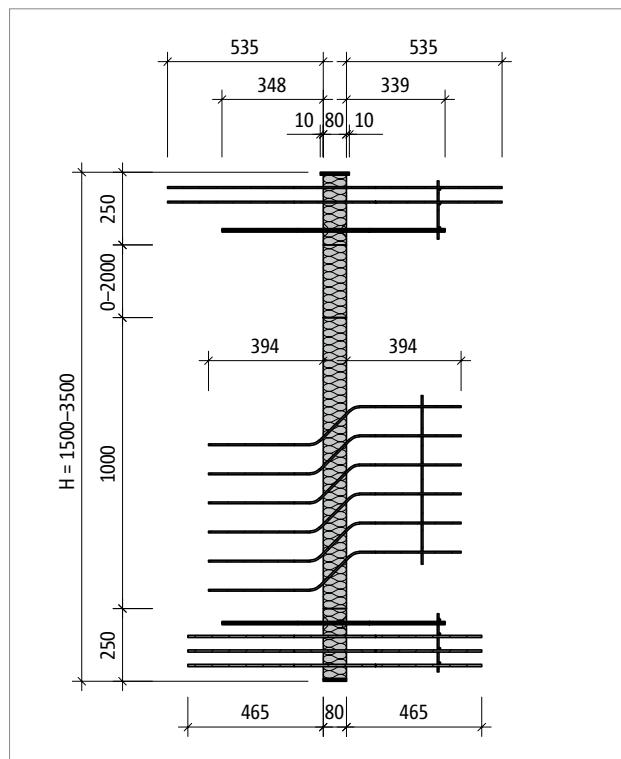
Schöck Isokorb® T type W-M1-R90 : coupe du produit ; plaque de protection incendie supérieure et inférieure
